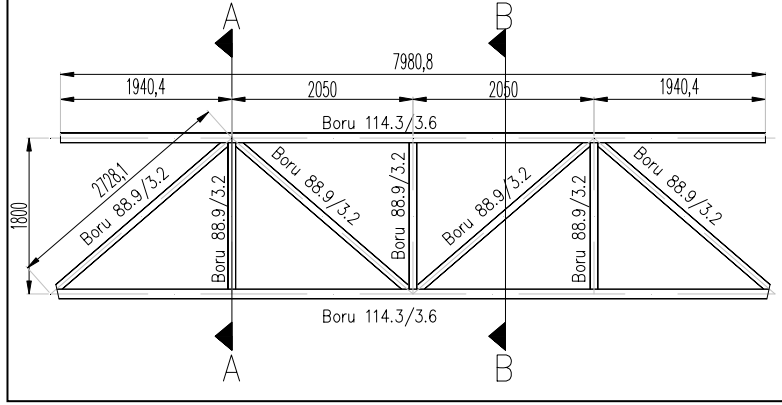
Ara kafes kiriş kesiti (mm)
